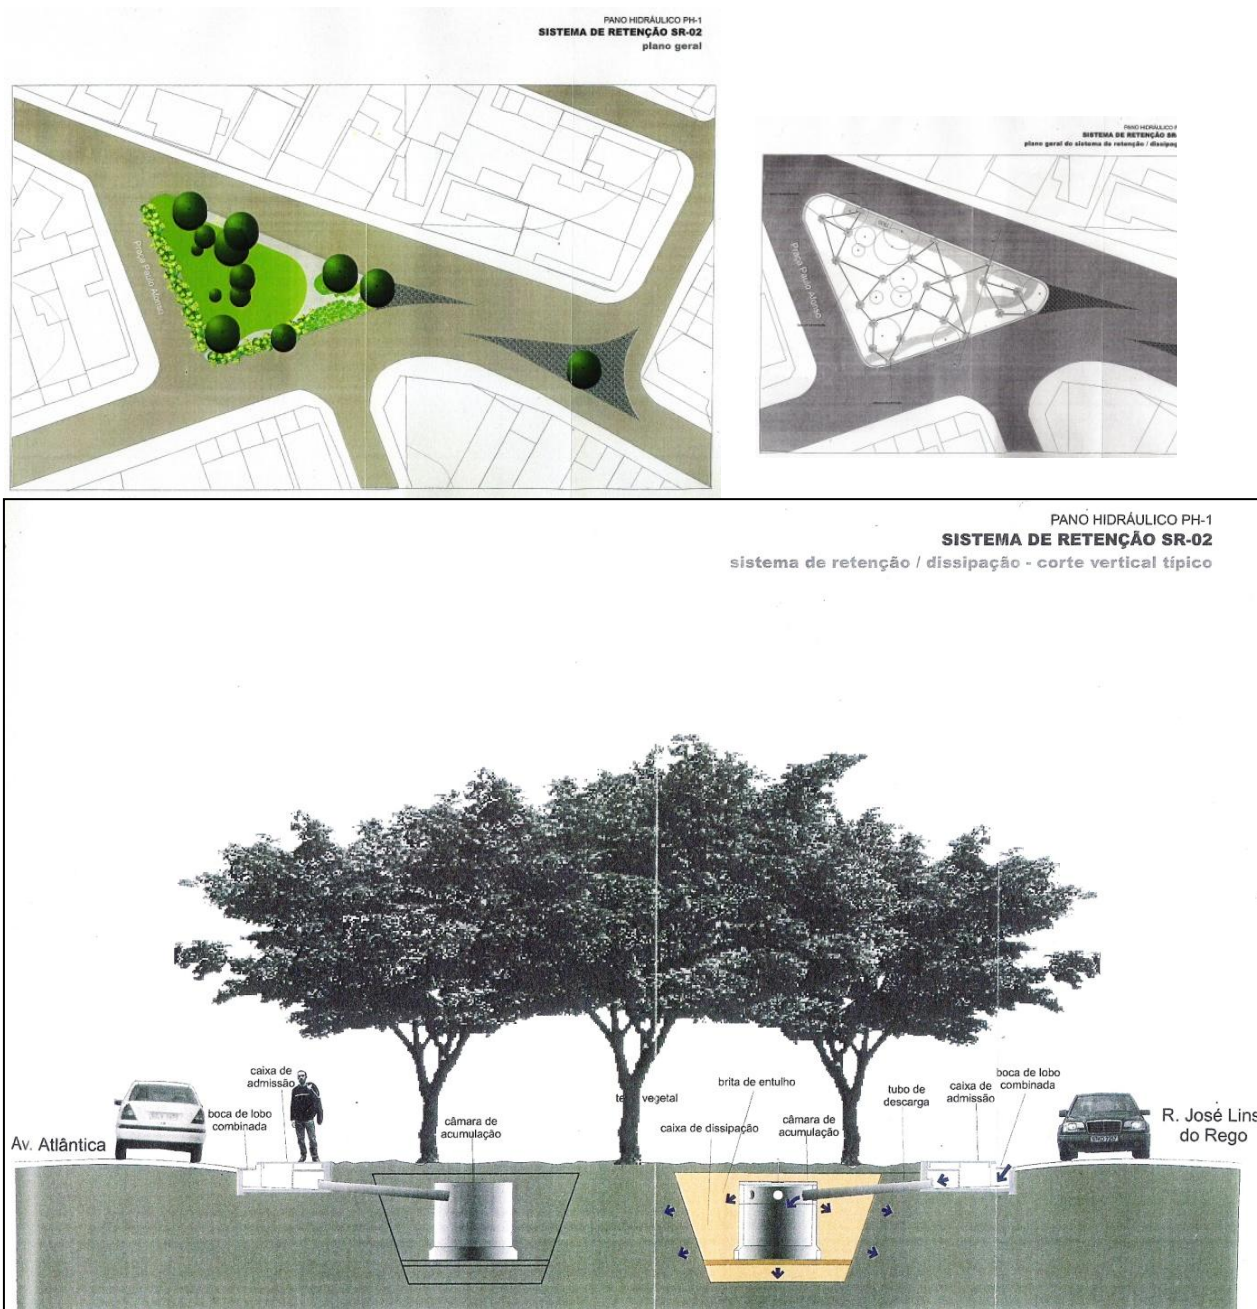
Planta de SR-2 (à esquerda) e corte horizontal mostrando o plano geral do sistema de retenção / dissipação. (LIMA, 2004).
